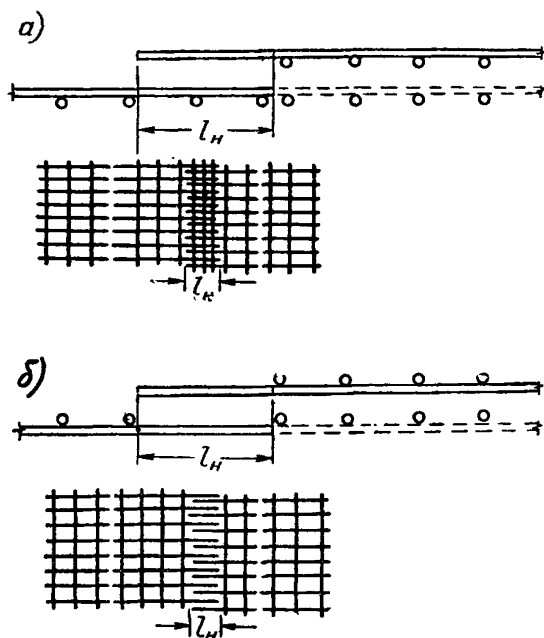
Стыки сварных сеток из стержней периодического профиля в рабочем направлении внахлестку (без сварки)
